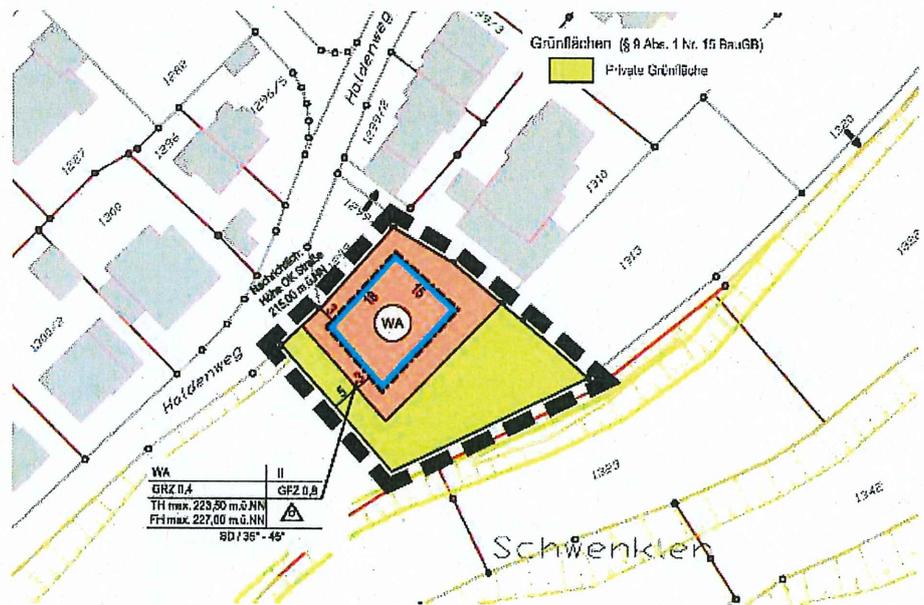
B-Plan zum Plangebiet mit Wohn- und Grünfläche (fsp 16.04.18)
